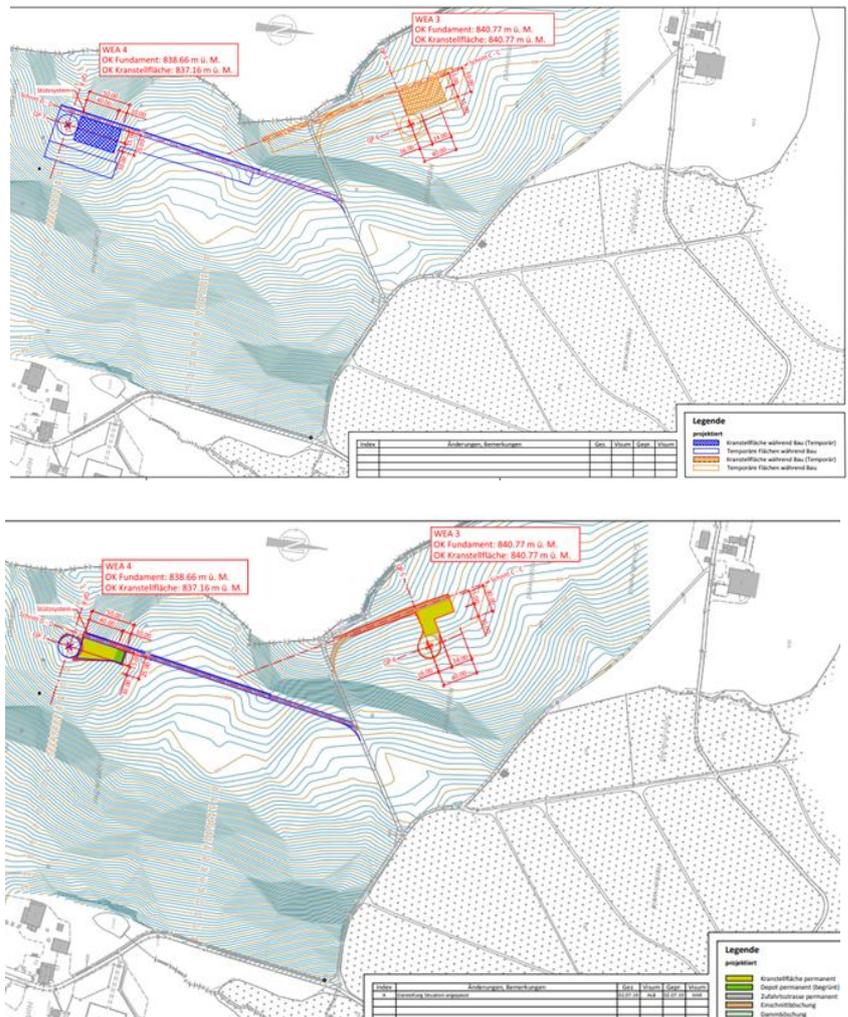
Standorte WEA 3 (links) und WEA 4 (rechts) im Teilperimeter Horben während der Bauphase (oben) und im Betrieb (unten). Die Kranstellflächen werden teilweise rückgebaut oder wiederbegrünt. Darstellung nicht massstäblich.
